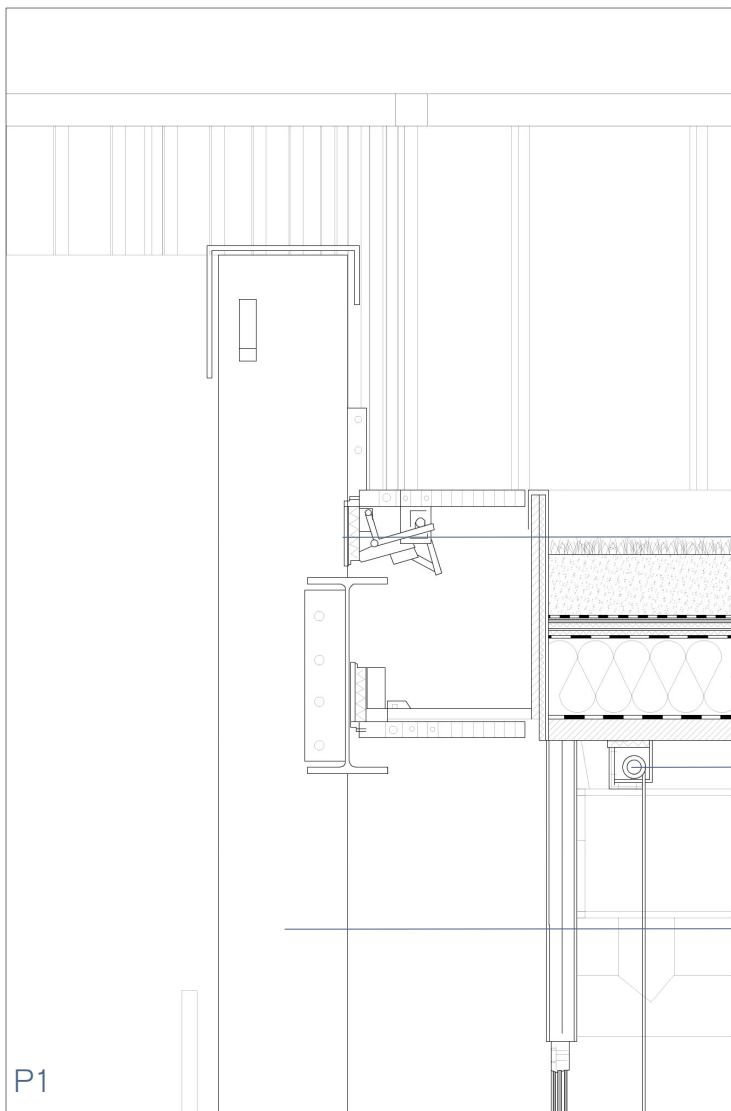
Módulo construtivo como somatório da cobertura, fachada interior, fachada exterior, piso 1, passadiço e estrutura.
